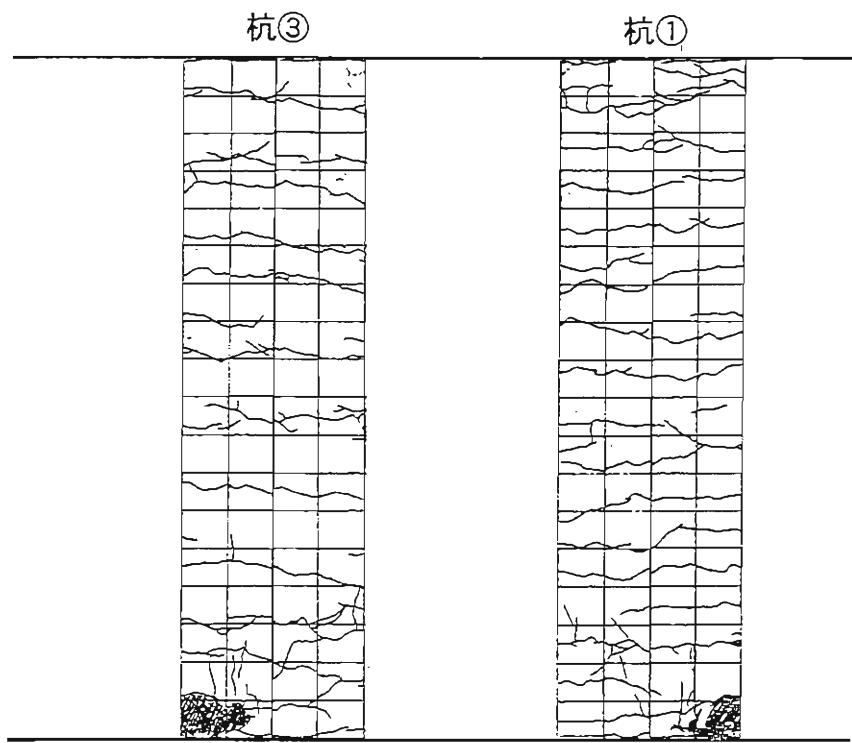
桁体のひび割れ状況展開図（ケース2、 $4\delta_y$ ）
